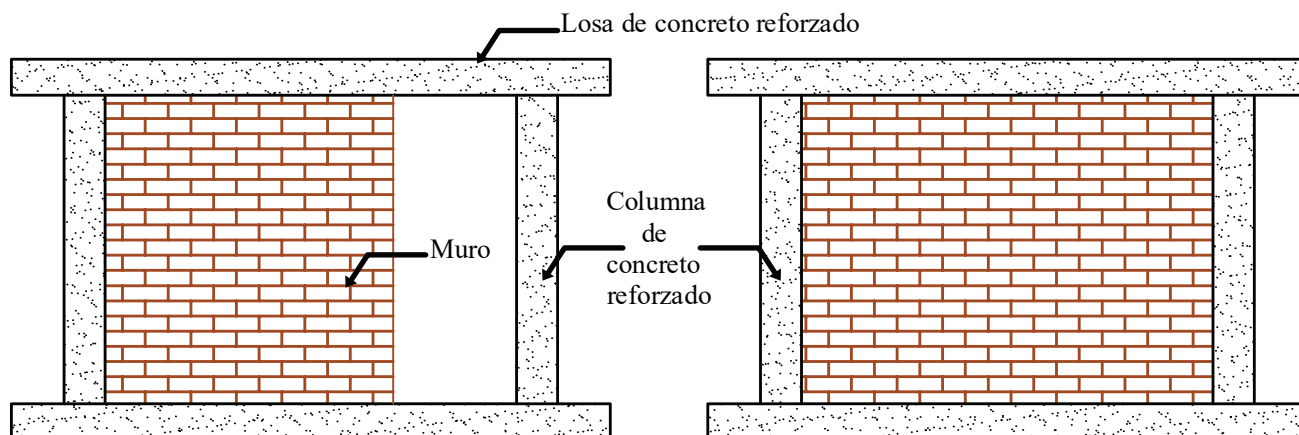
Ejemplo de muros no estructurales y muros estructurales.
